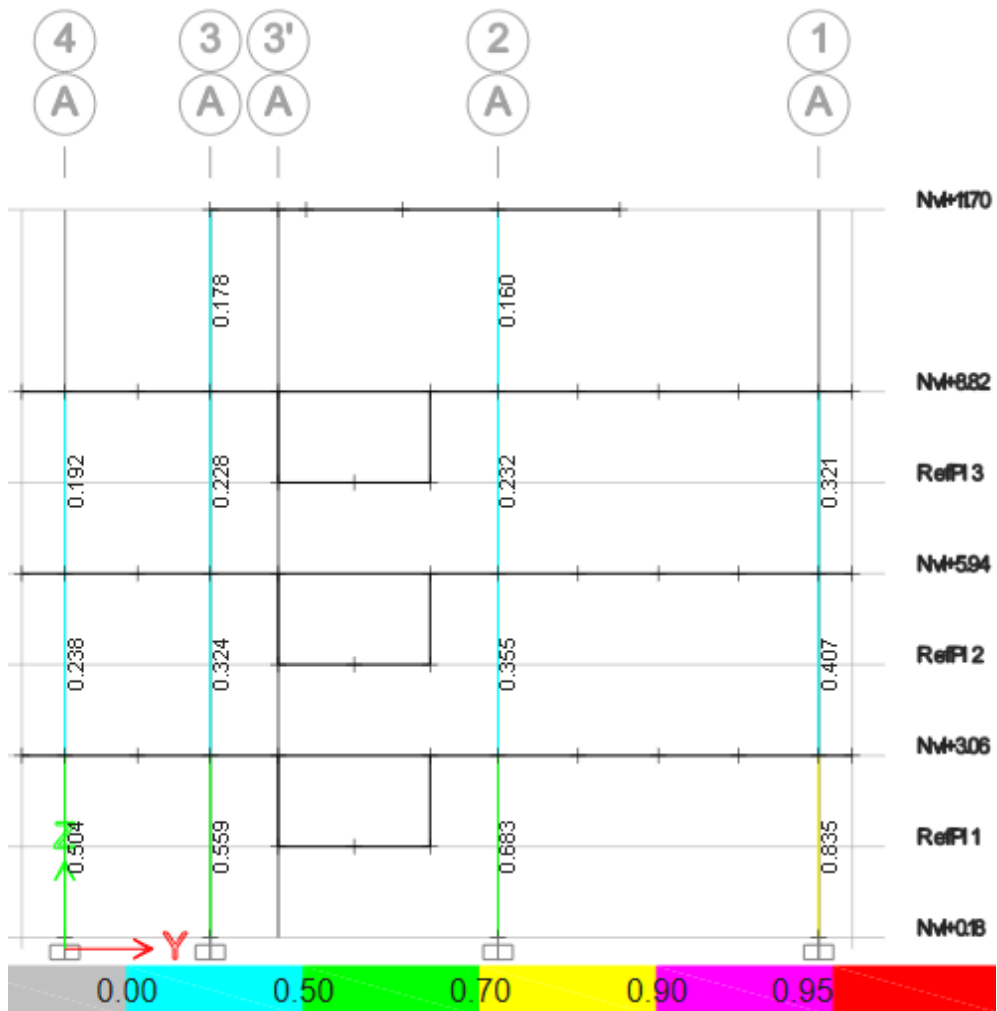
Diseño de columnas rellenas de hormigón del eje A
